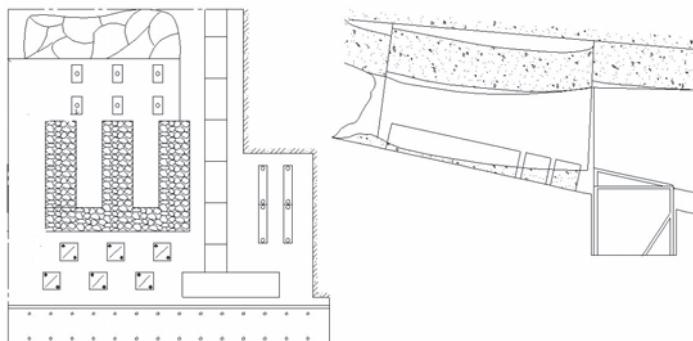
Схема возведения бутовой полосы и органной крепи с последующим удержанием пород кровли на тумбах из БЖБТ, установленных в шахматном порядке
